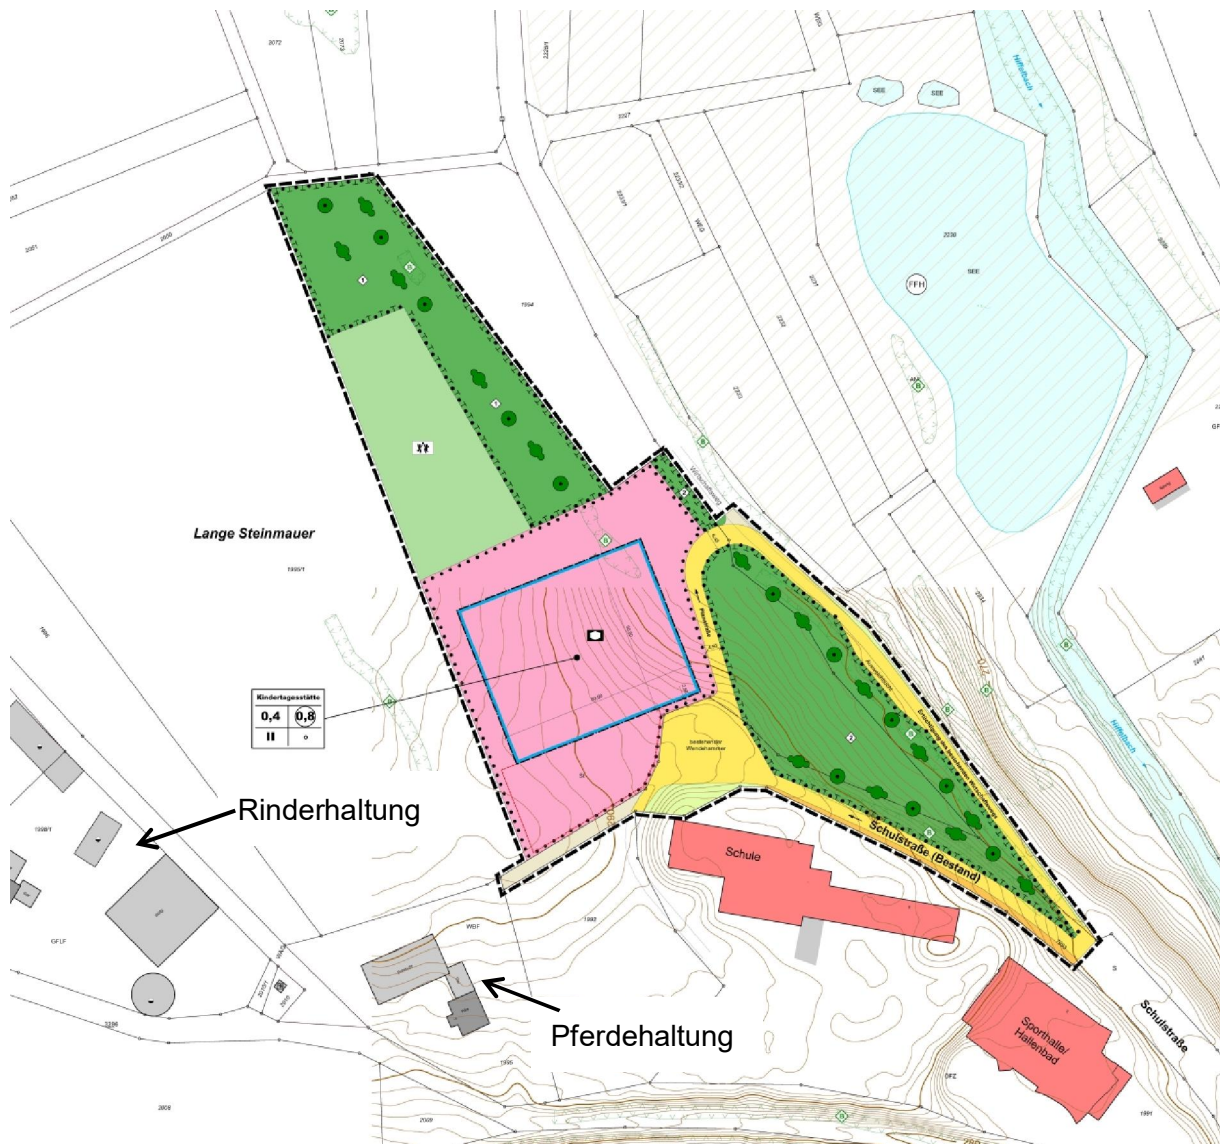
Bebauungsplangebiet mit in blau eingezeichneter Baugrenze des Kindergartens
